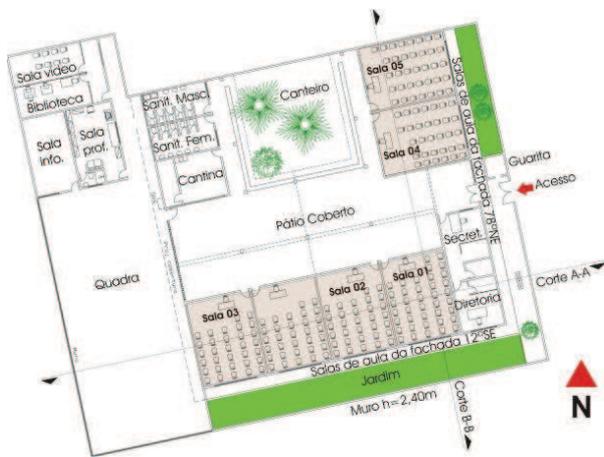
Planta baixa da escola indicando acesso e localização das salas de aula.
